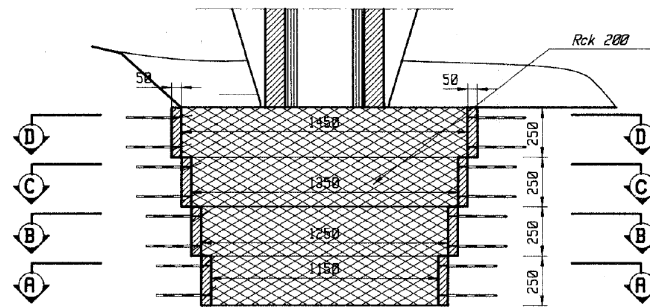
Sezione fondazioni “a pozzo” - pile 2 e 3
